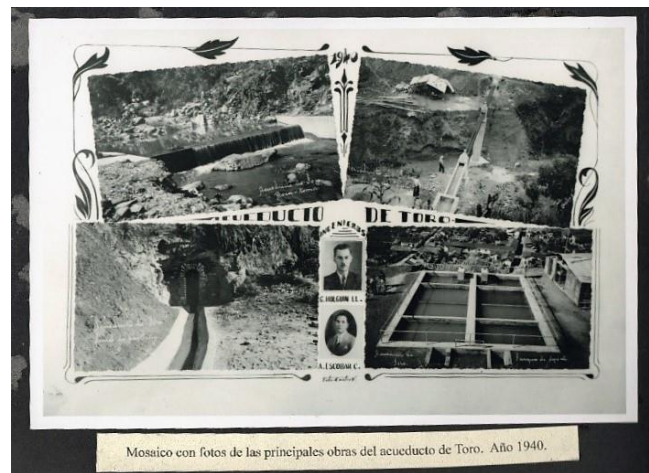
Foto Collage con vistas a la construcción del acueducto y los ingenieros de la obra.
